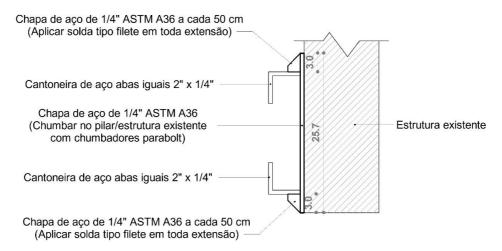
Fixação dos perfis cantoneiras na chapa de aço de 1/4" de espessura.
